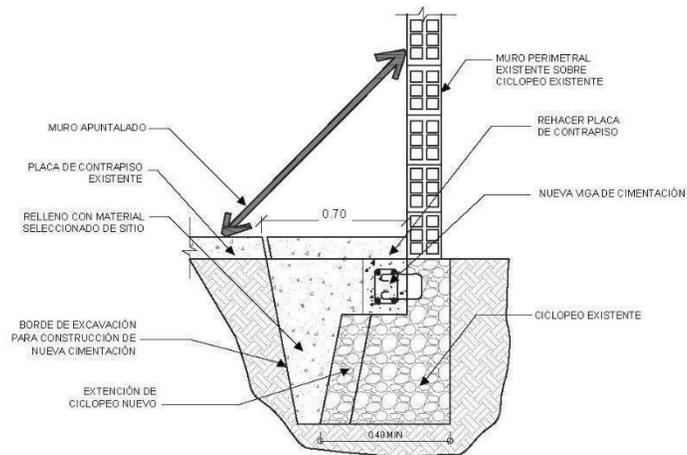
Nueva viga de cimentación en concreto reforzado para muros internos sobre concreto ciclópeo existente.
